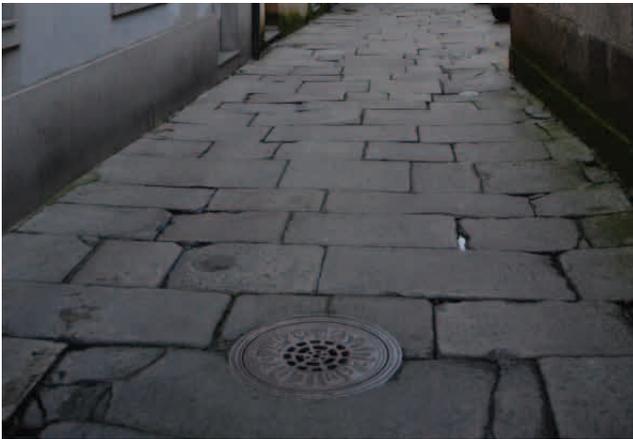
Estado del pavimento junto a la Colegiata (fuente propia, c/Santa María)
